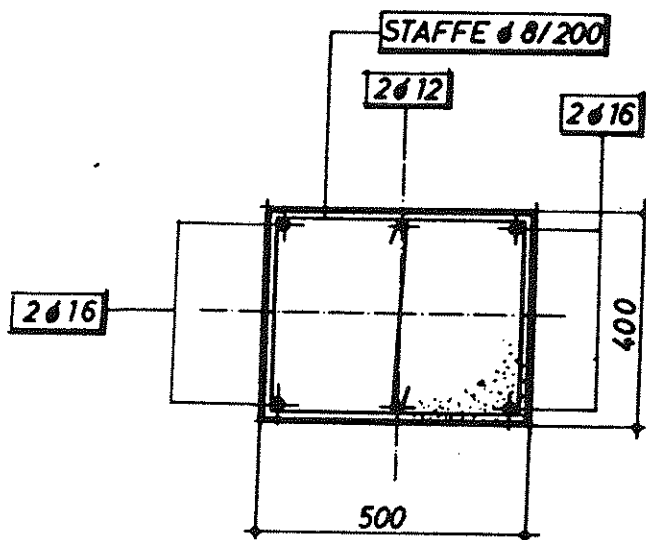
Caratteristiche geometriche e disposizione della armatura per il pilastro centrale
